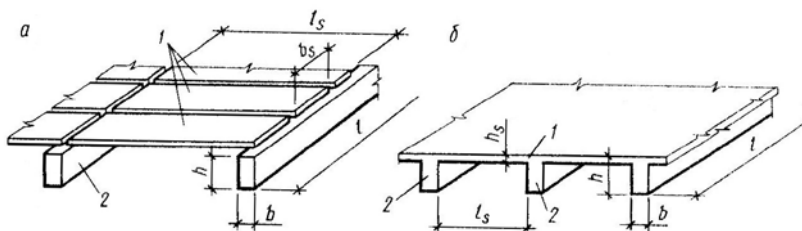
Изгибаемые железобетонные элементы: *a* – сборное перекрытие; *б* – монолитное перекрытие; 1 – плиты; 2 – балки
